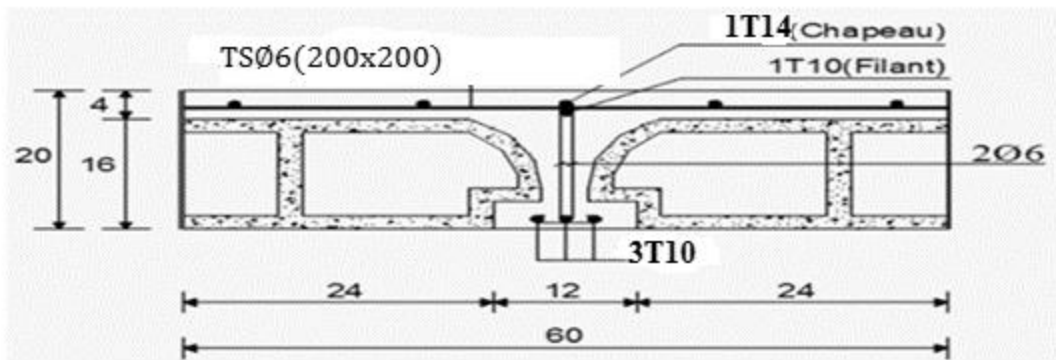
Coupe transversale d'un plancher à corps creux.
